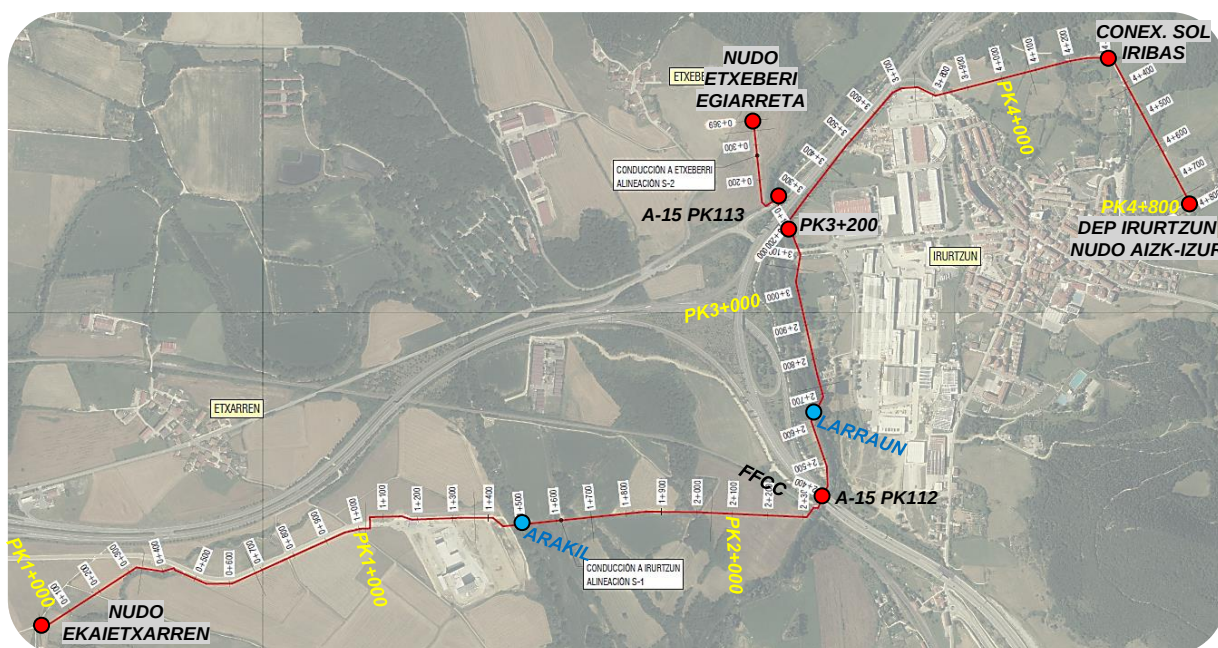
Planta general del trazado diseñado para la conducción entre el nudo de Ekai-Etxarren y el Depósito de Irurtzun
